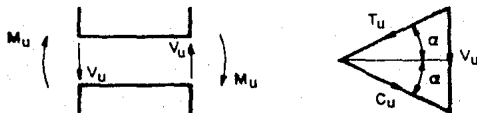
b) Acciones externas e internas en una viga de acoplamiento.
